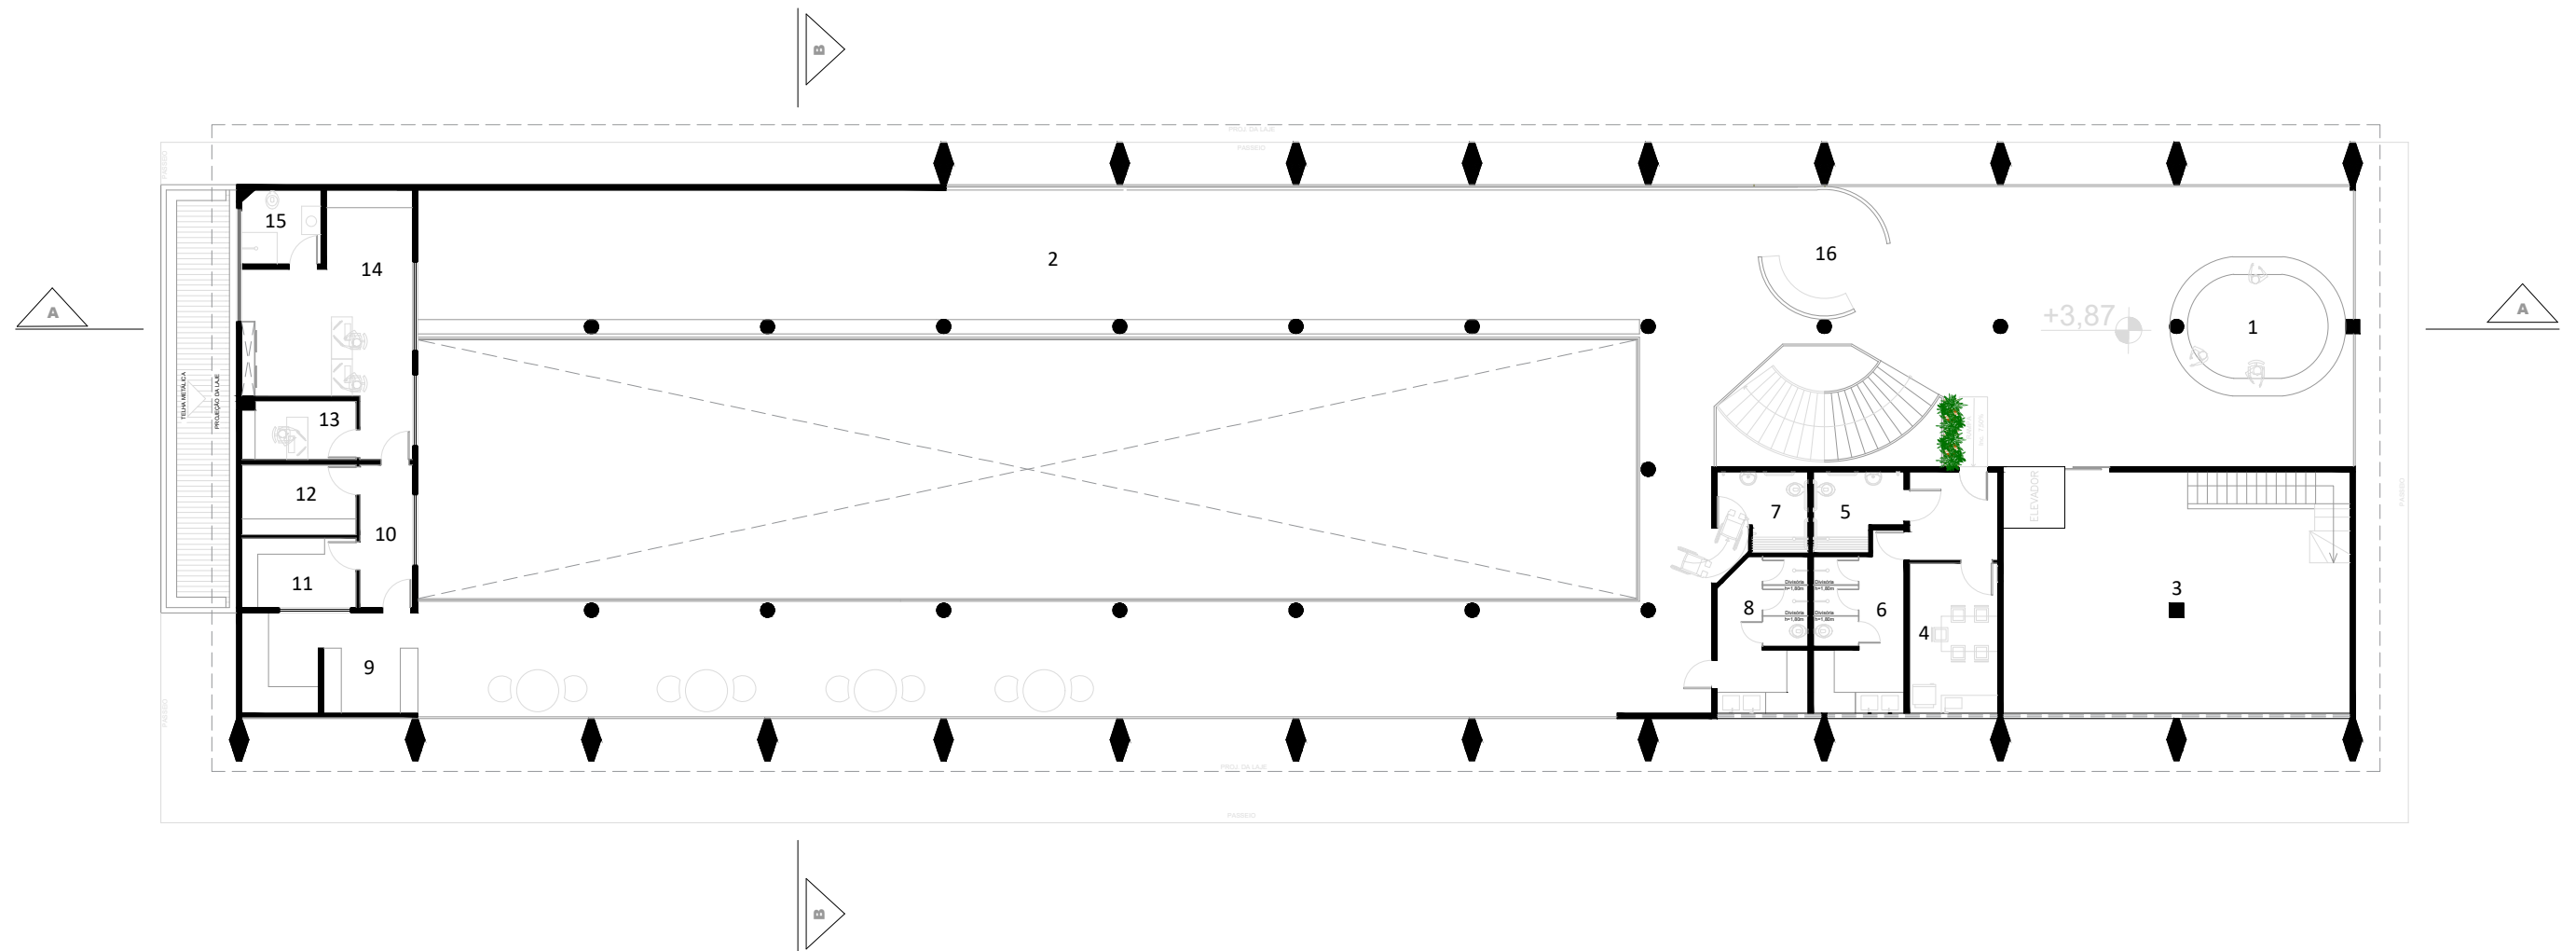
2022. / Planta do pavimento térreo. ©Planta conseguida na SEDURBS. Modificada pela autora.
